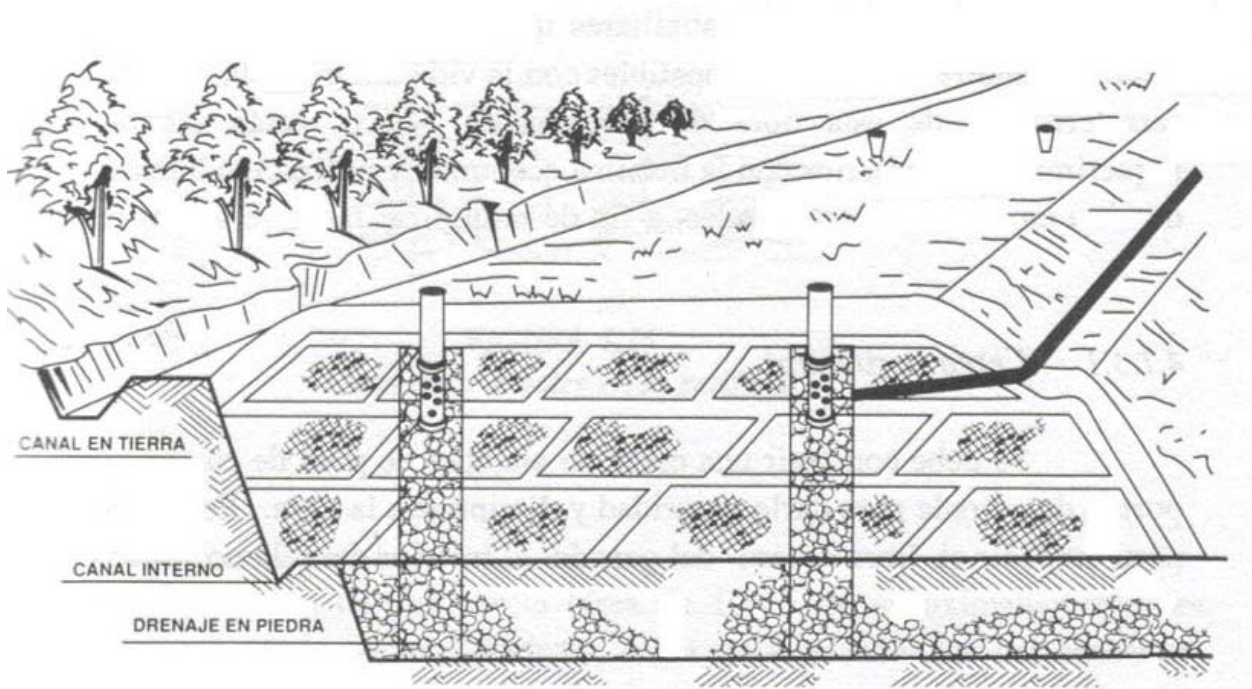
Colocación de Chimeneas sobre Canales de Drenaje
